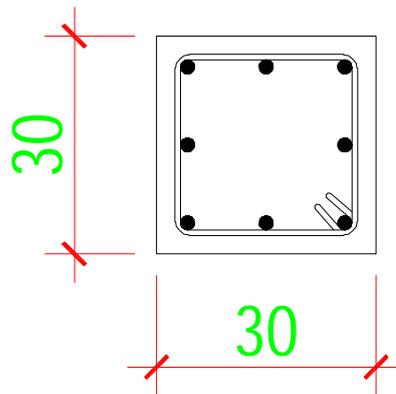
Penulangan Plat, Balok, dan Kolom
